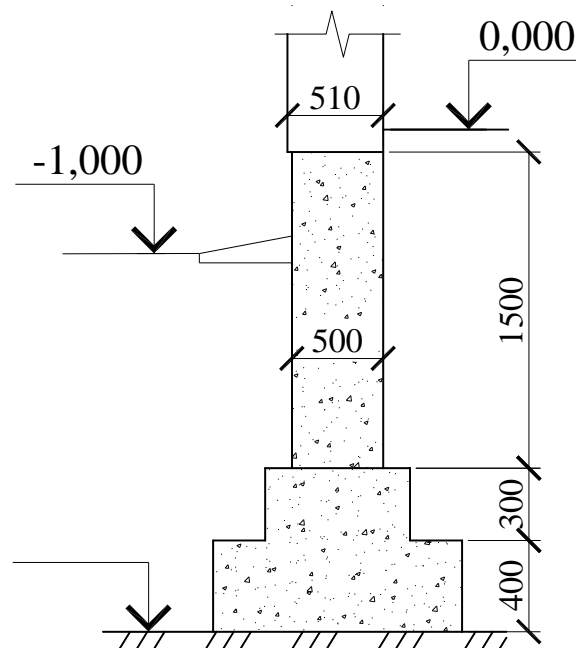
Стрічковий бутобетонний фундамент
